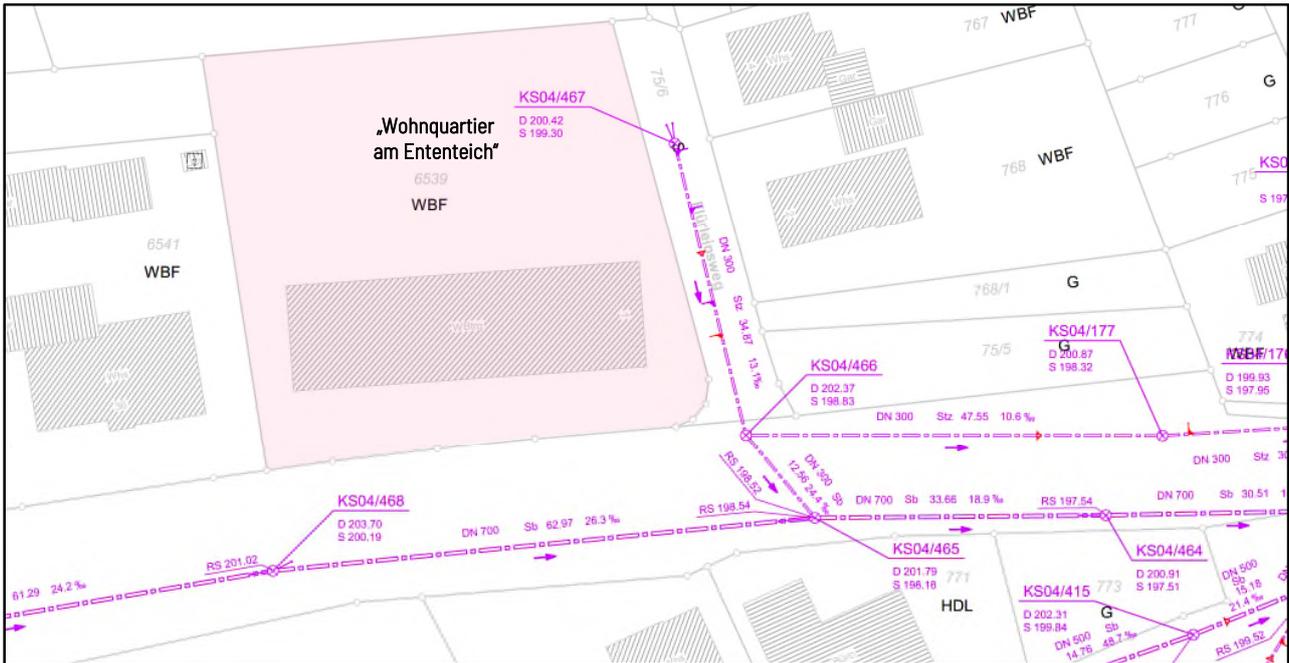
Auszug aus dem Kanalbestandsplan „Lauda Süd“ mit Darstellung des Baugrundstücks – Quelle: Stadt Lauda-Königshofen
